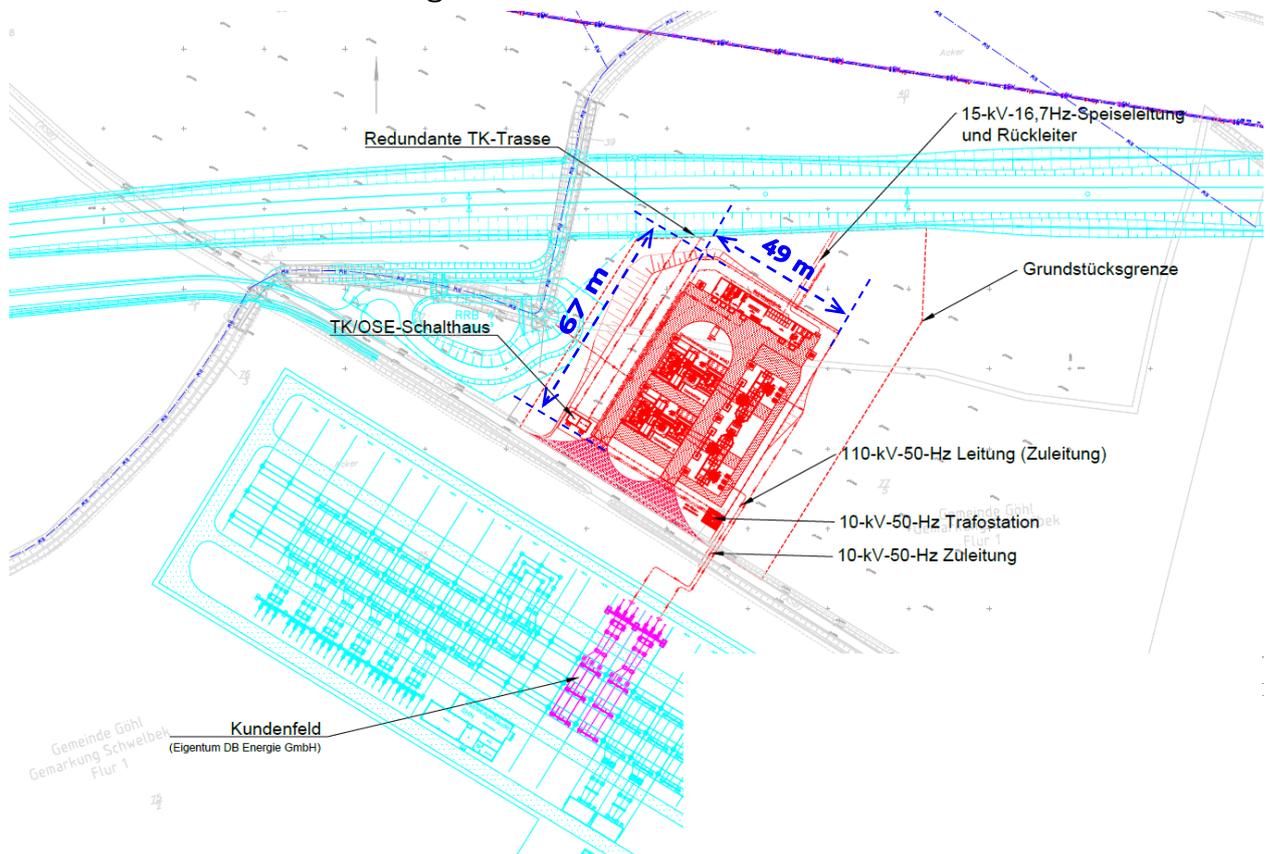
Lageplan des geplanten Umrichterwerks Göhl
